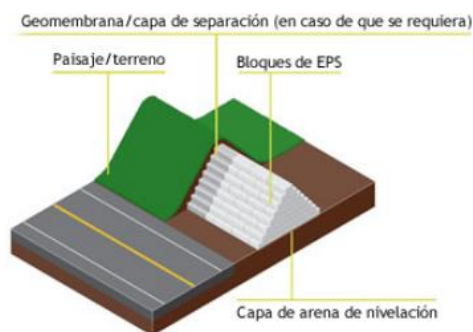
EPS en barreras de sonido (anape)
